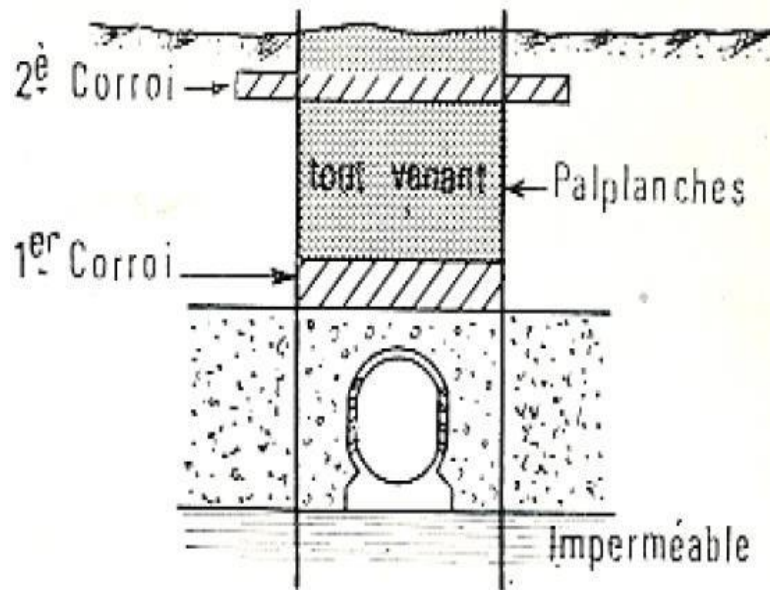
Figure I.18 Mise en place d'un drain (Dupont, 1978)
